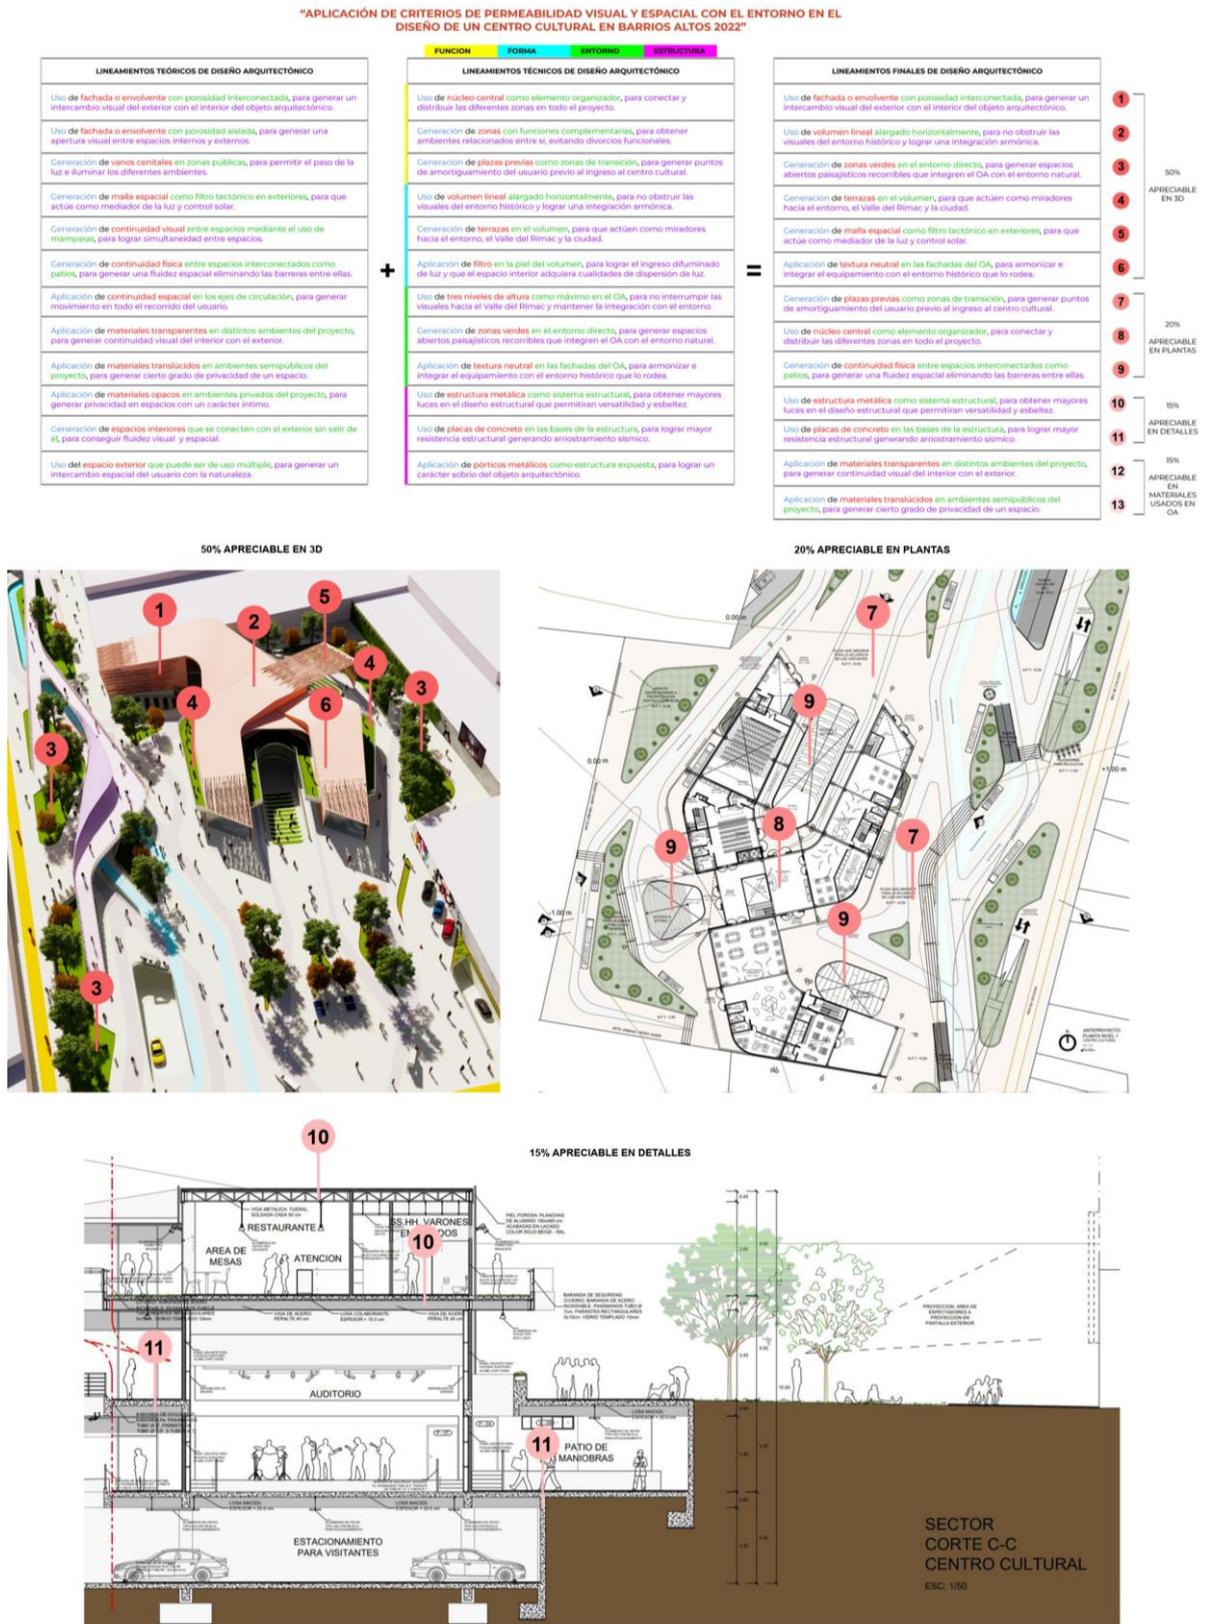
Aplicación de los lineamientos de diseño arquitectónico en el Objeto arquitectónico
